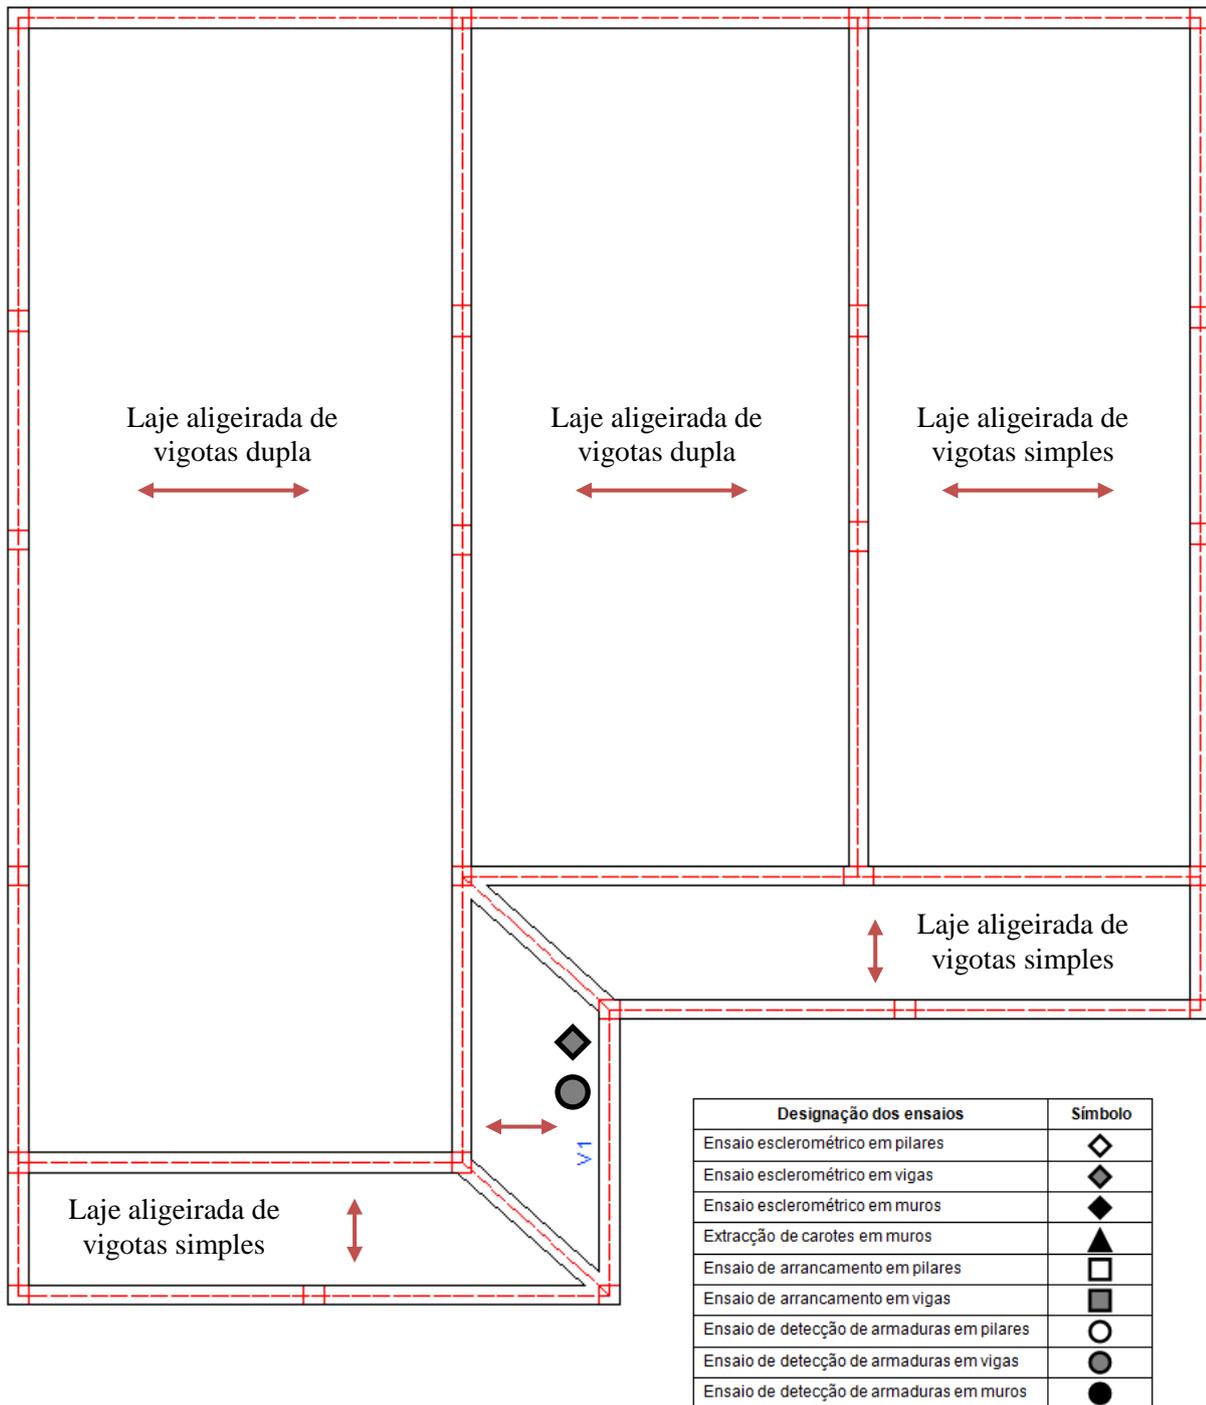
Planta estrutural da Rés-do-Cobertura (localização dos ensaios)
